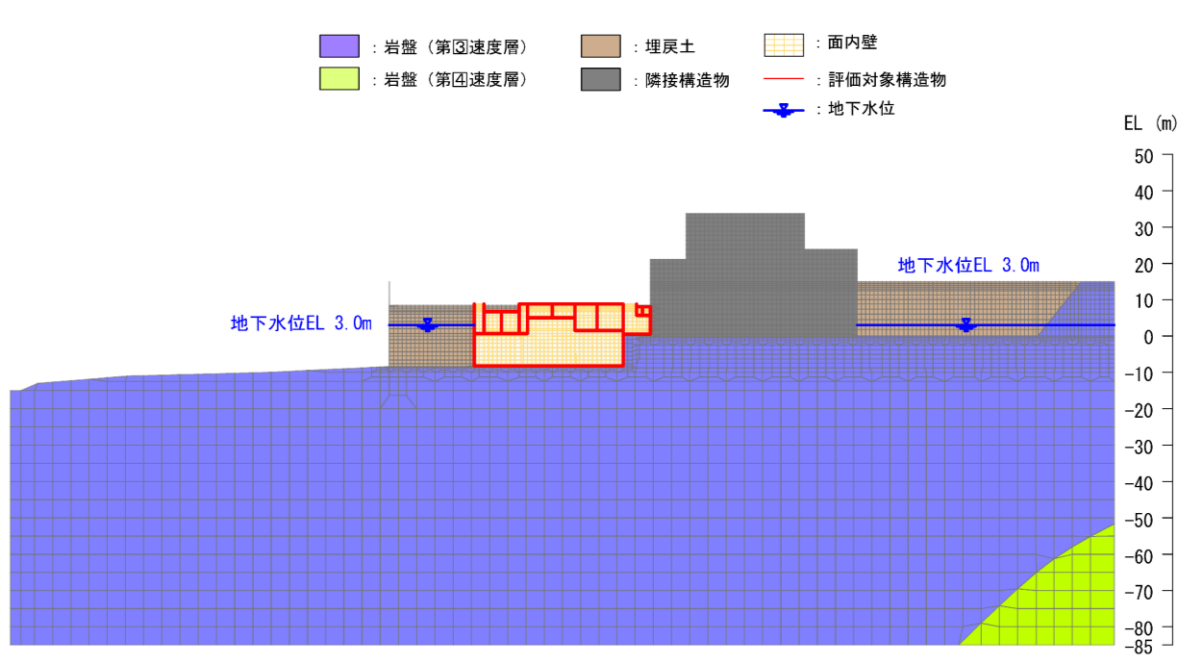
1号機取水槽 地震応答解析モデル図 (南北断面)
